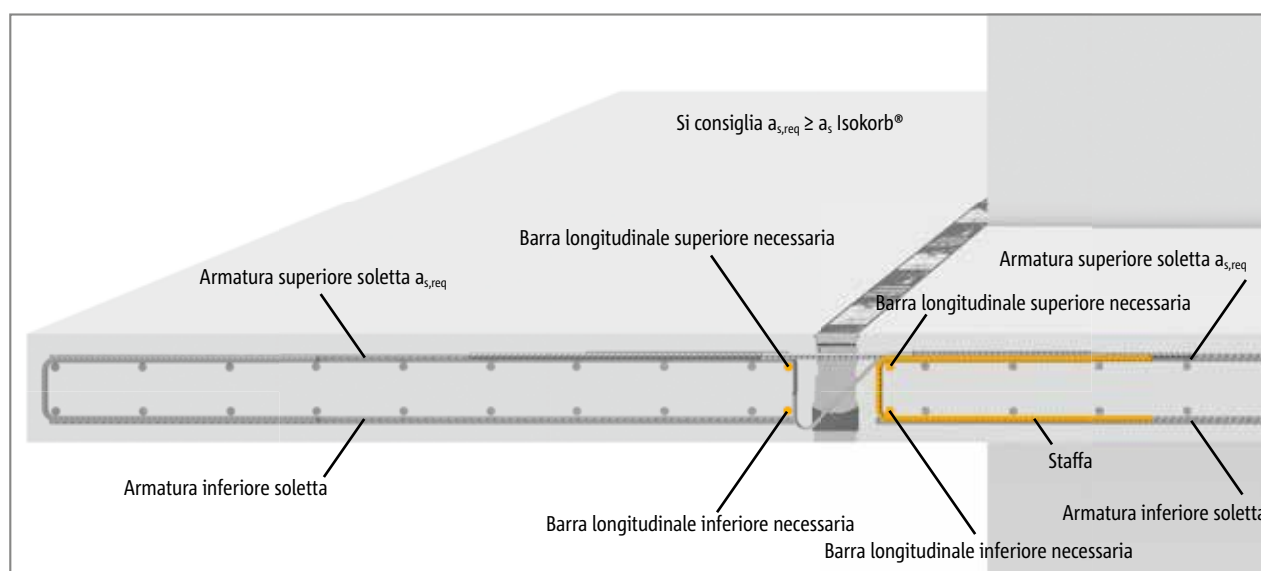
Schöck Isokorb® T tipo KL: armatura in opera in caso di supporto indiretto
